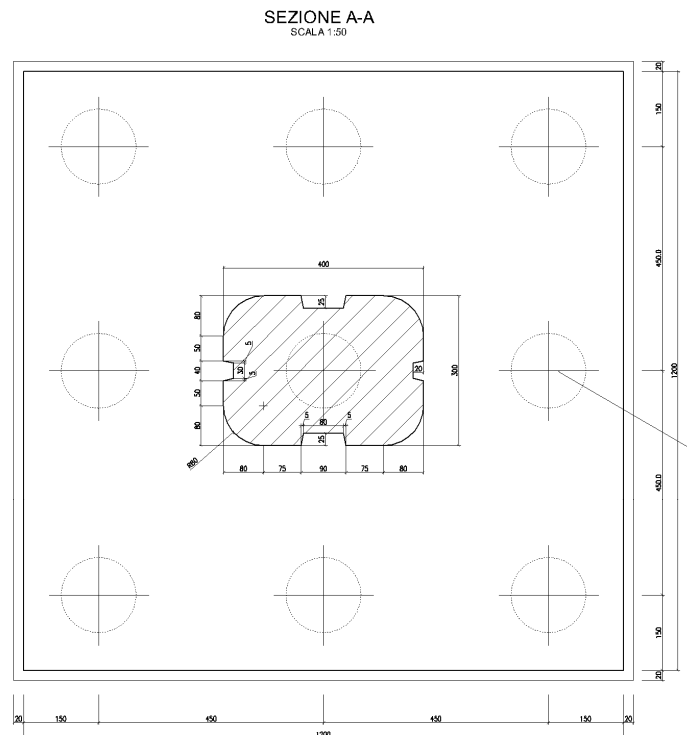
Pianta del plinto di fondazione tipo A.
